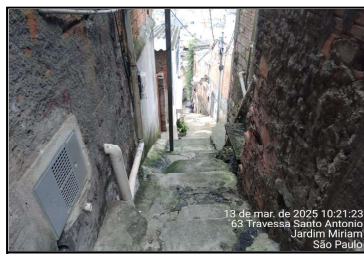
TRAVESSA SÃO JOAQUIM
